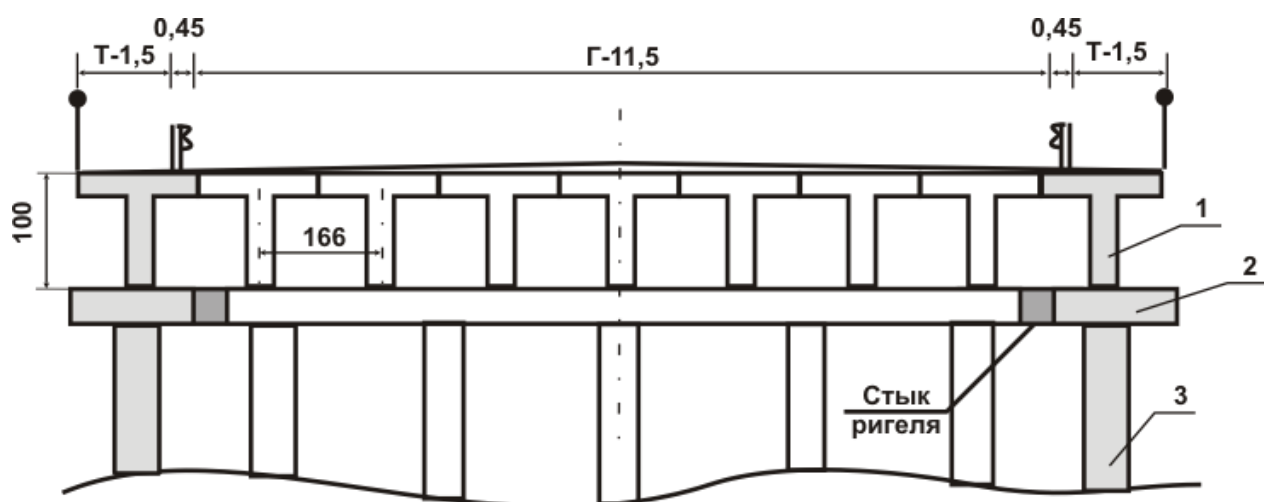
Уширение моста приставными балками с опиранием их на удлиненный ригель и дополнительные опоры: 1 – приставные балки; 2 – удлиненный ригель; 3 – дополнительные опоры
